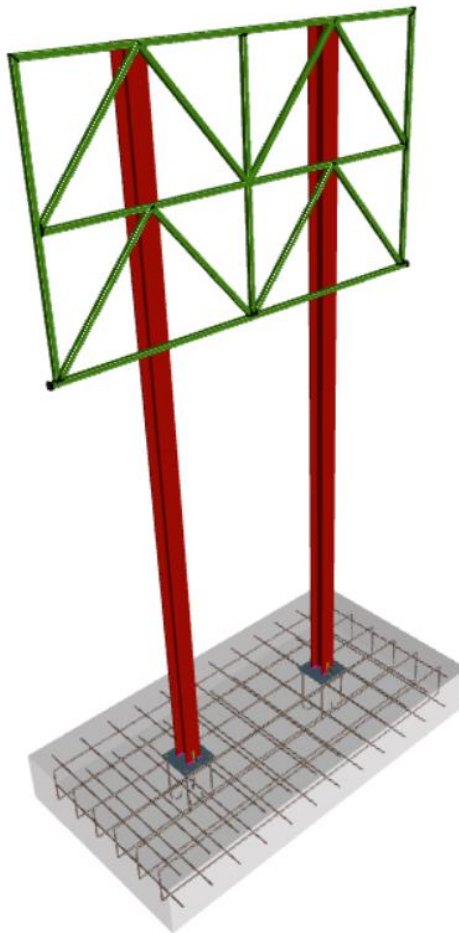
Imagen 3D de la estructura y cimentación del poste publicitario.
